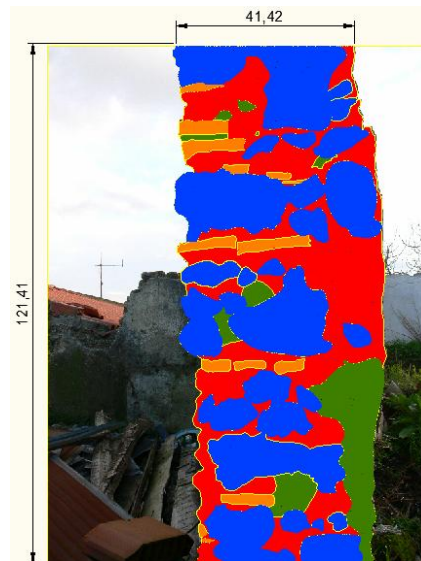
Elementos constituintes da secção transversal na Rua da Liberdade - Monte da Caparica
